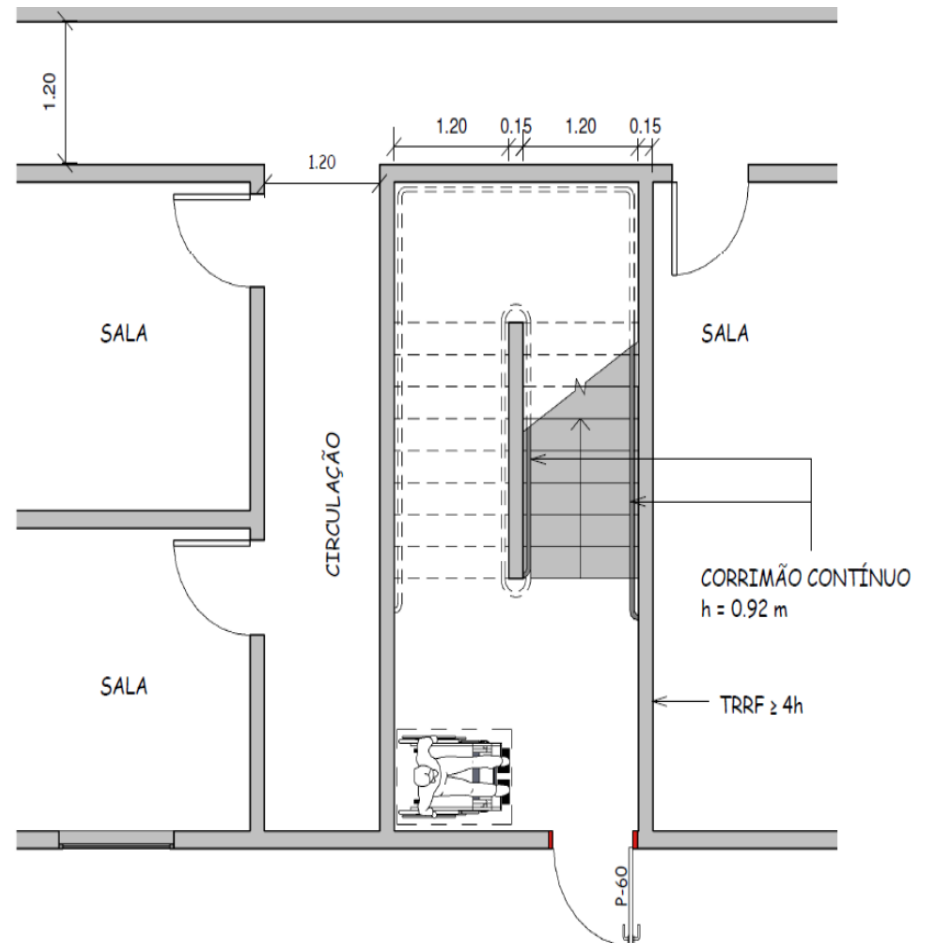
A - Escada à prova de fumaça aberta - térreo (planta baixa).
